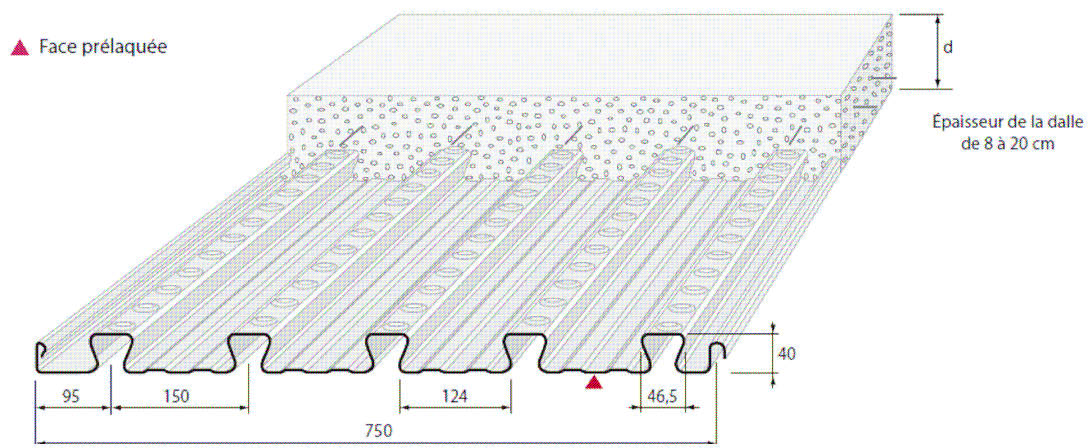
Constitution d'un plancher de type bac collaborant
